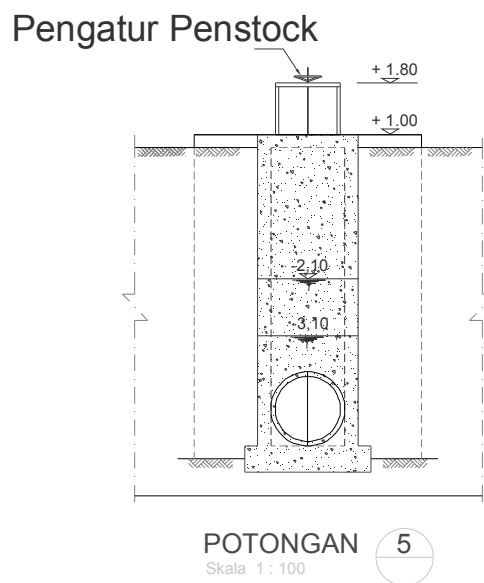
Potongan 1 bangunan pengambilan bendung
